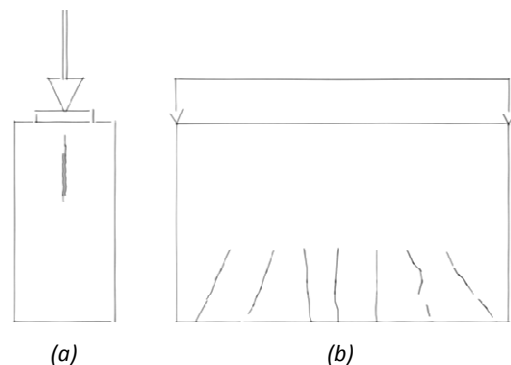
fisuración concentrada (a) y fisuración distribuida (b)
